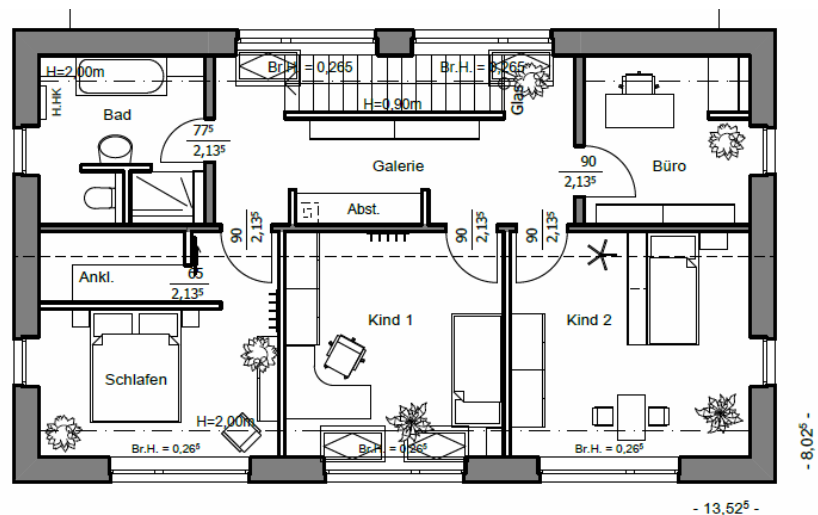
Grundriss OG des Konzepthauses
